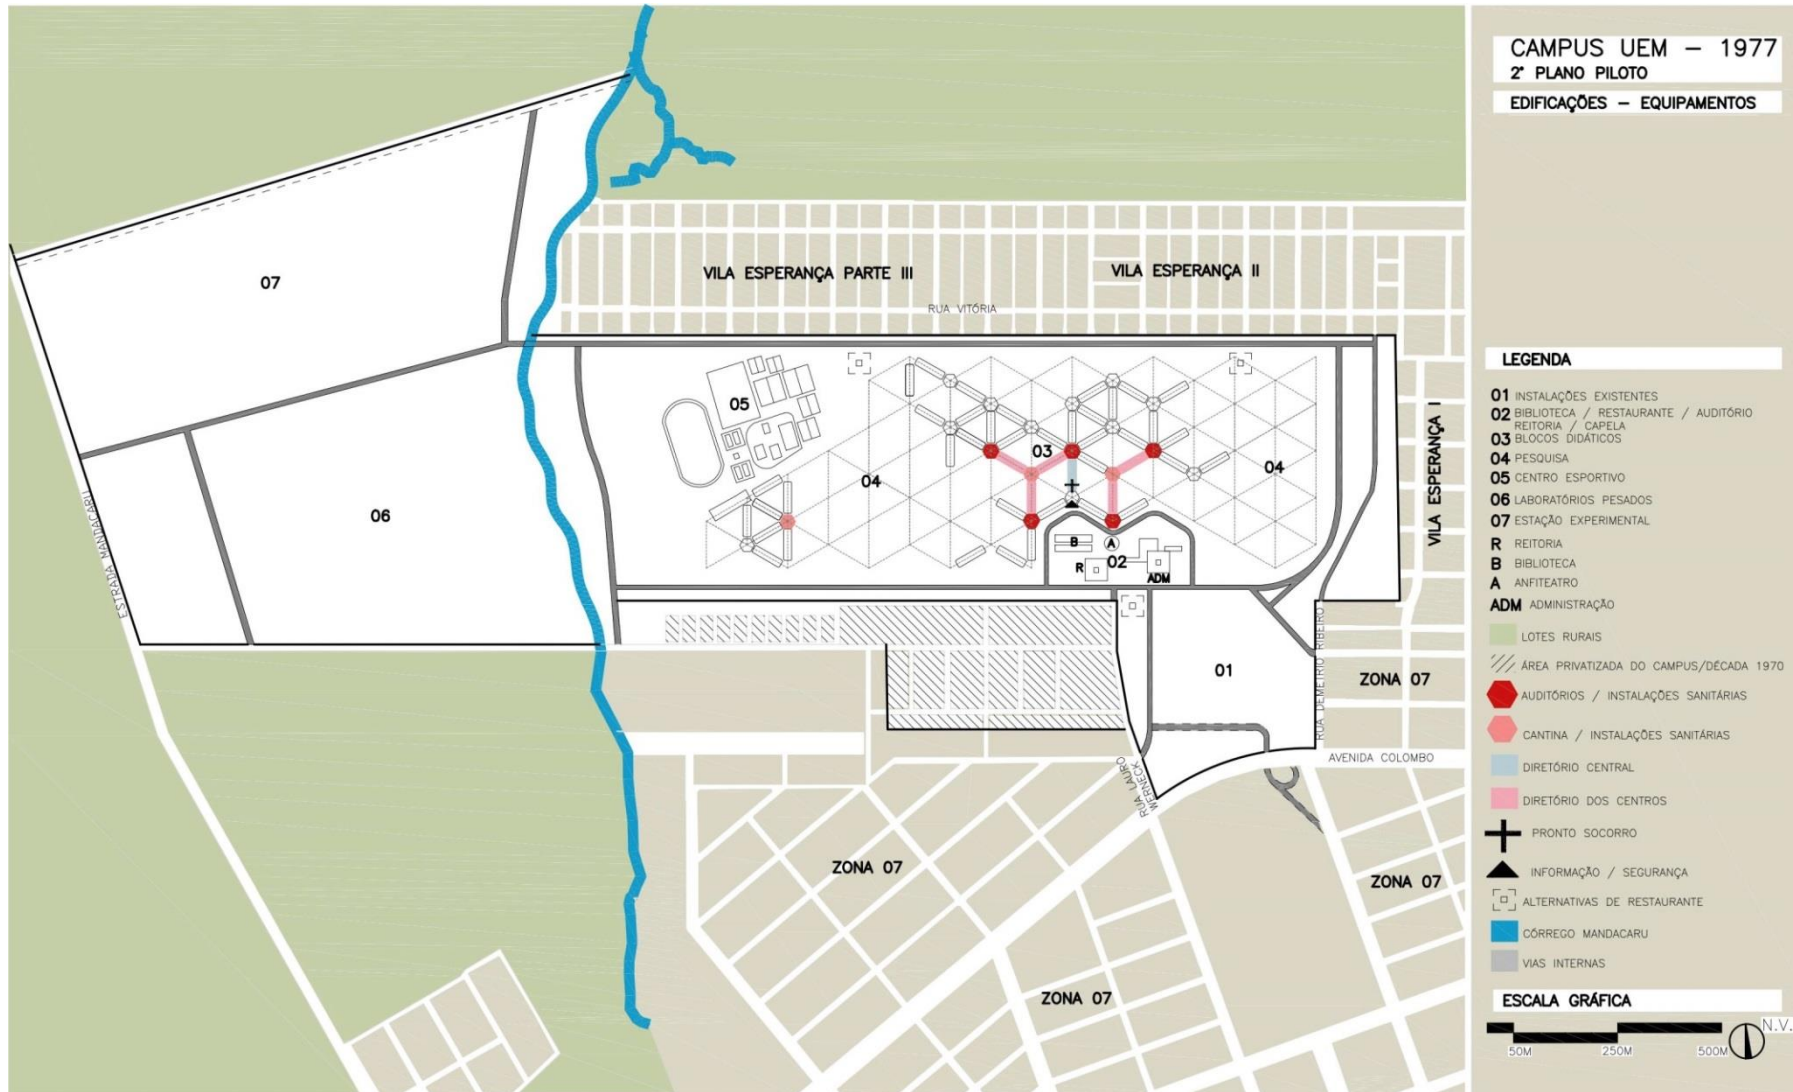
Equipamentos relativos à 1ª Etapa do 2º Plano. Fonte: Prancha 05 – Plano Piloto 1977. Disponível na DOP/PTO. Desenho Renan Avanci.
